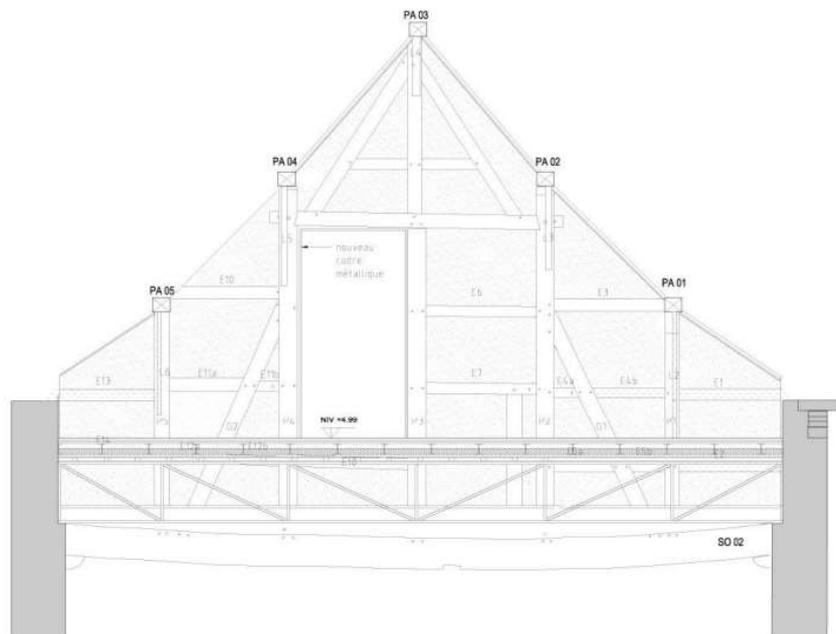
Coupe faite dans le corps de meunerie, issu du document de S-PASS Territoires , mettant la poutre treillis en avant (s.d.)
